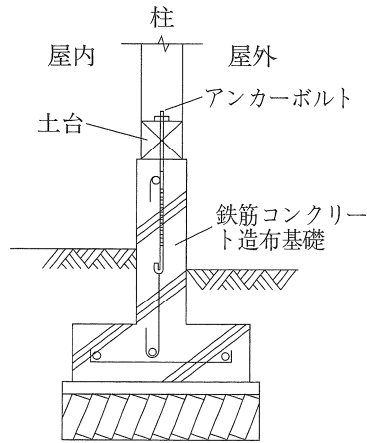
土台を鉄筋コンクリート造布基礎に緊結した例
